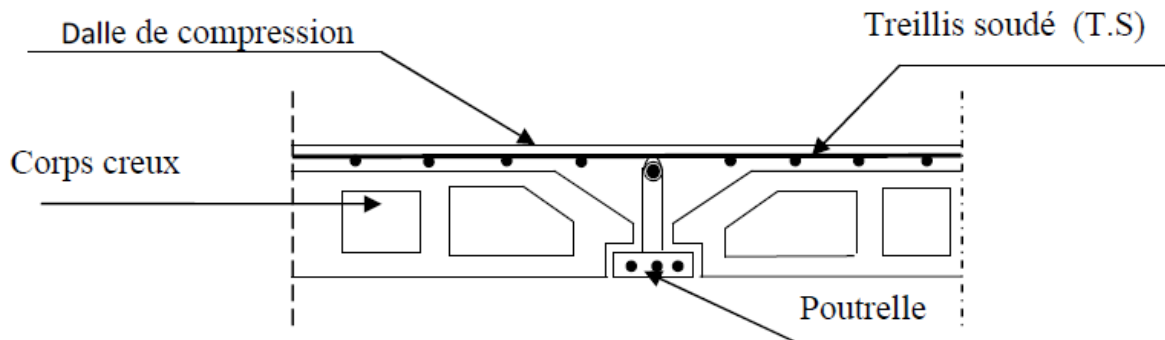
Coupe verticale d'un plancher en corps creux.
